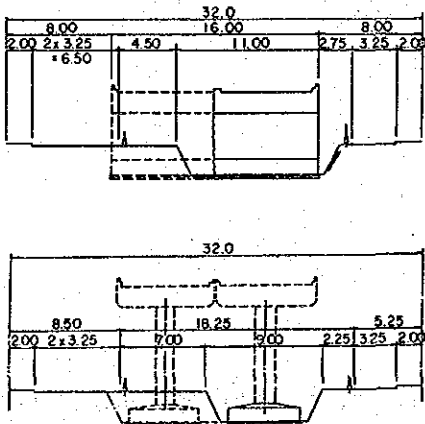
SECCION TRANSVERSAL DE LA CALZADA PARA EL DESVIO DE TRANSITO DE LA AV.R.DE FRANCIA
